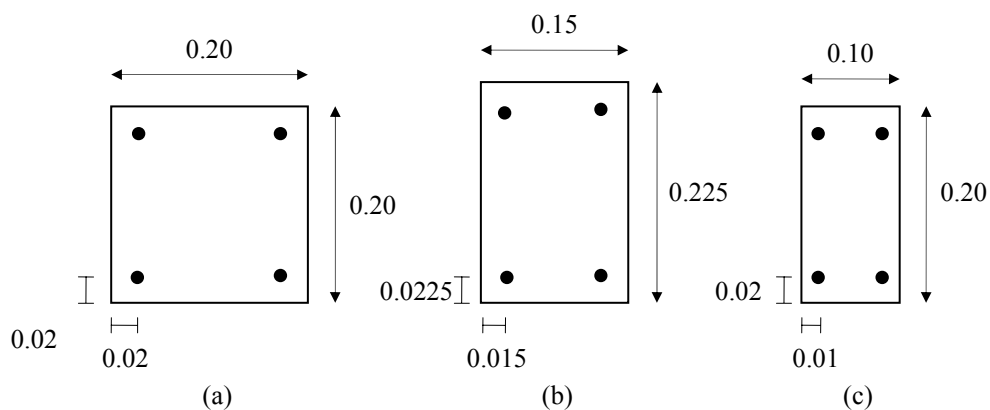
Sección transversal tipo. Distribución de armadura en las cuatro esquinas.
